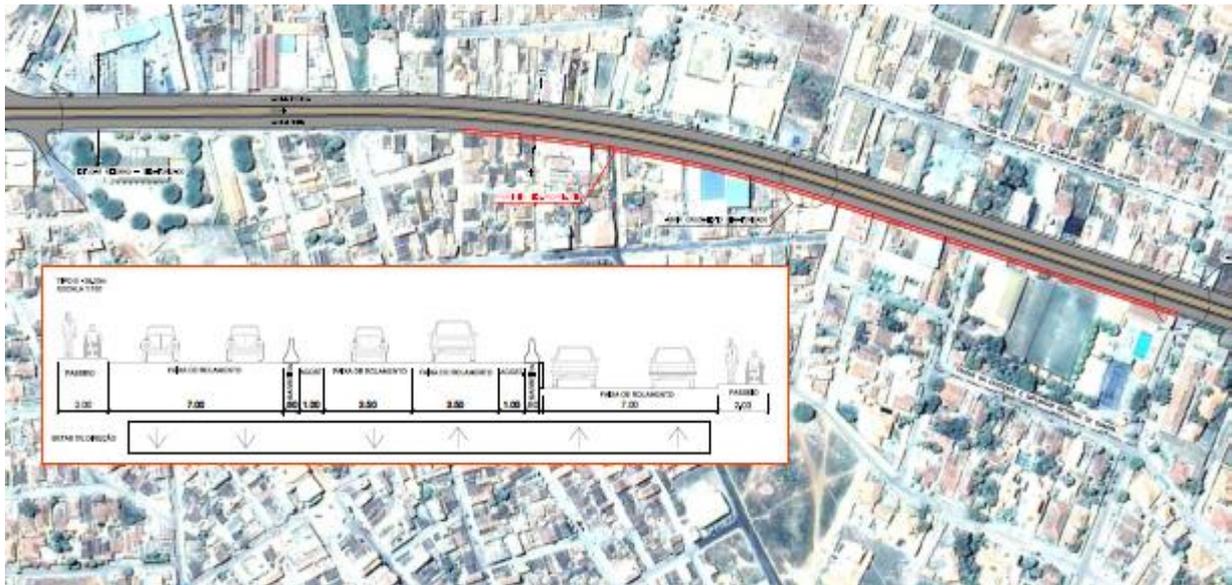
Trecho da intervenção proposta para Irecê.
